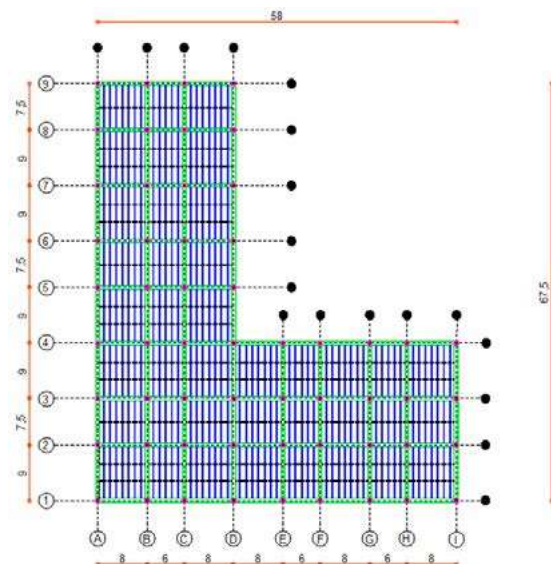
Geometría en planta para las edificaciones (medidas en metros)
